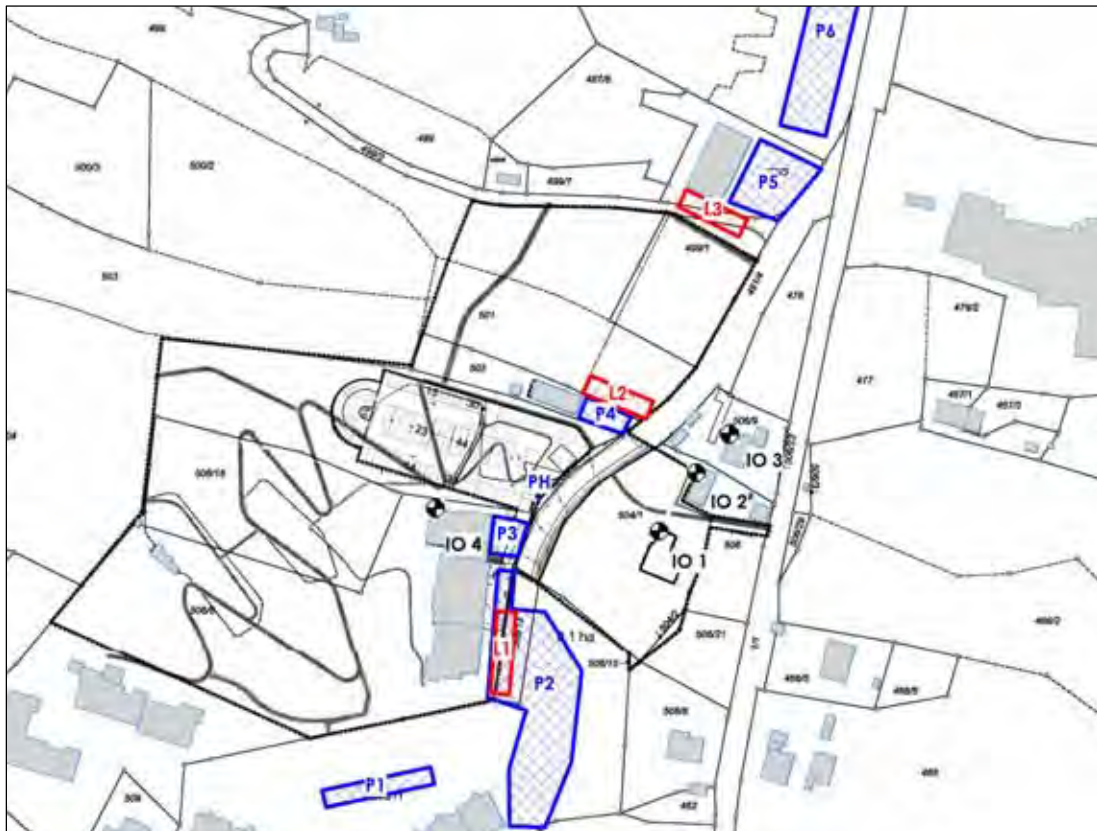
Lageplan mit Darstellung der Schallquellen für den Gewerbelärm
